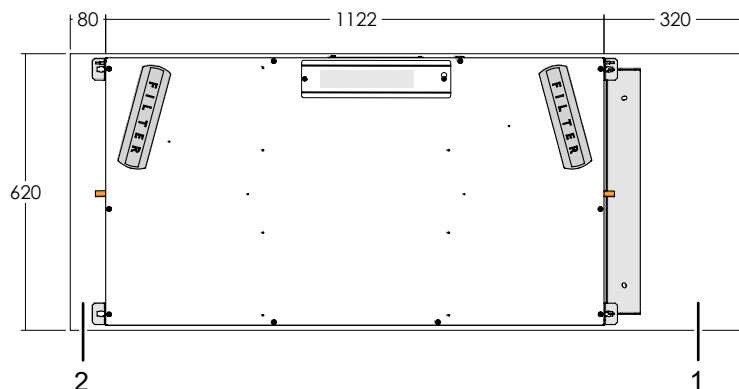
espace nécessaire en cas de montage au plafond en mode B
